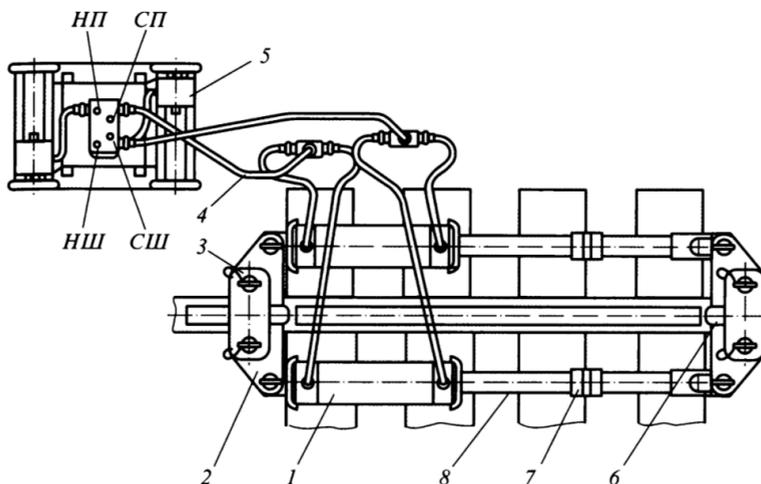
Натяжитель СПН-100-500 (вид сверху) и гидравлическая станция СГР1-8: 1-гидроцилиндр; 2-захват;3- плита; 4- шланг высокого давления; 5-гидравлическая станция; 6 – пружина; 7 соединительные устройства; 8- удлинительные тяги; НП, НШ, СШ, СП вентили (клапаны)
